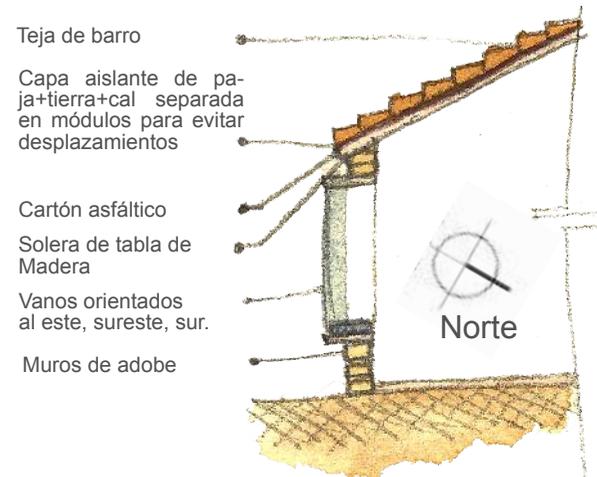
Elaboración del Autor. Detalle constructivo de materiales en techo y muros.
